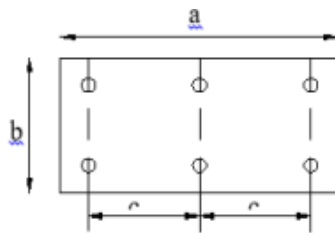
Espaceur entre les armatures longitudinales d'un poteau.
